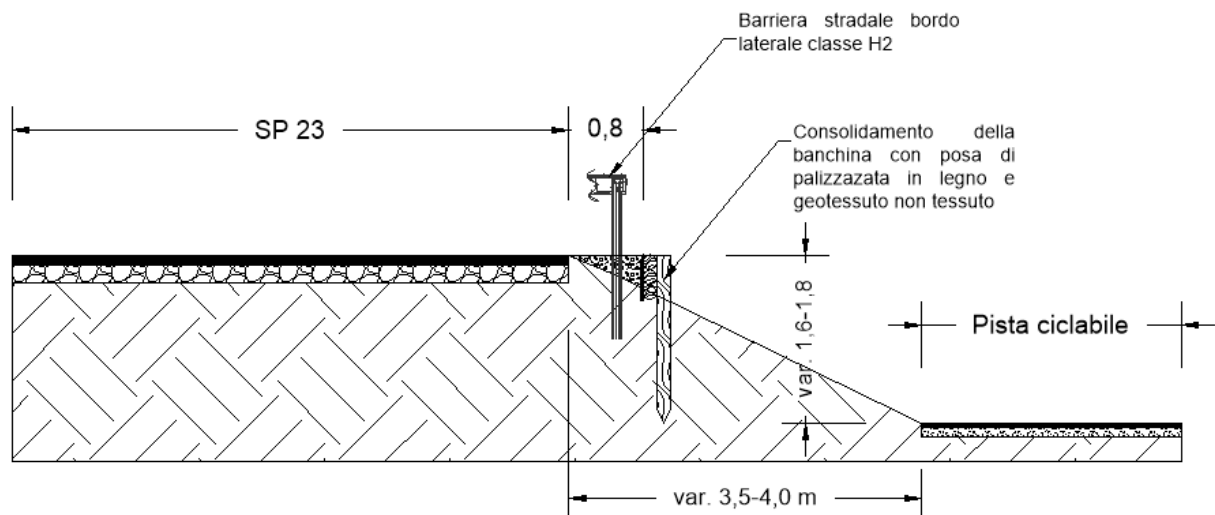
Sezione tipo dell'intervento di posa delle barriere bordo laterale.
